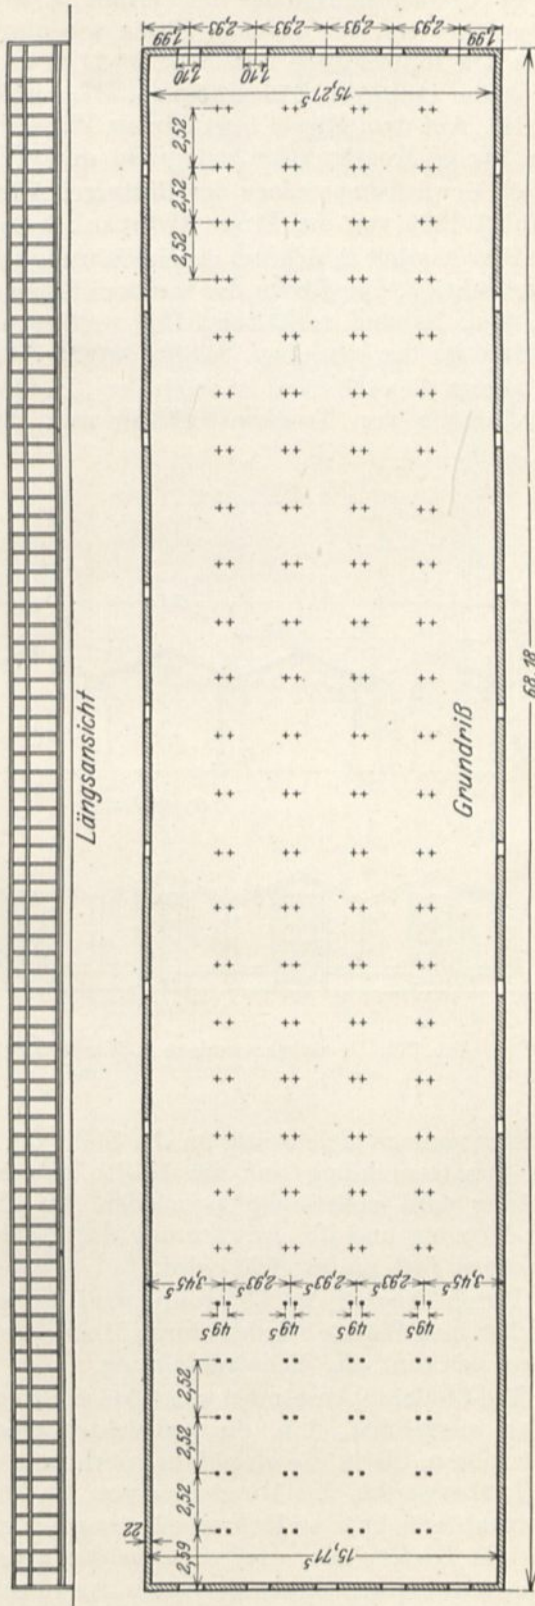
Gewächshausanlage der Firma A. Wachlin, Pyritz i. Pomm. Grundriß und Längsansicht. (Ausführung: Alfred Steinborn, Waren i. Meckl.)
